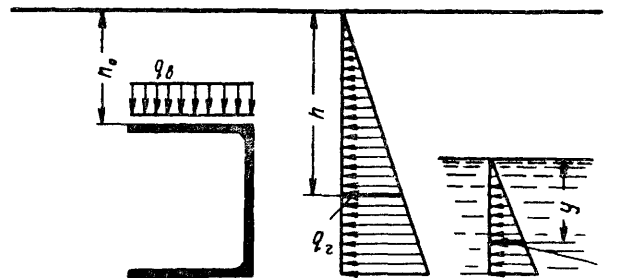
Схема нагрузки на подземное сооружение от грунта и грунтовой воды
